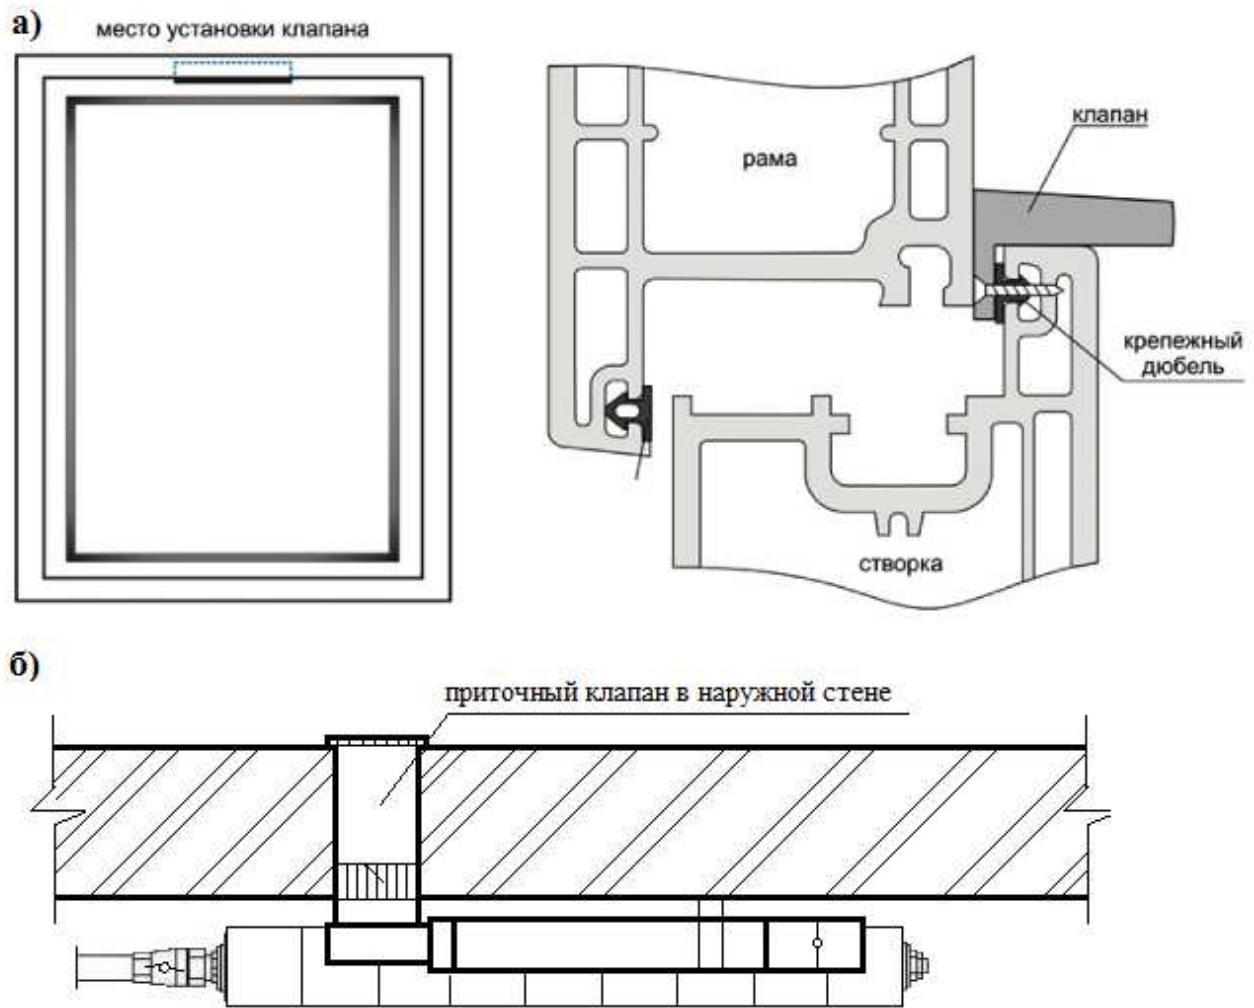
Условное размещение вентиляционных клапанов в окнах (а) и стенах (б) жилого дома
